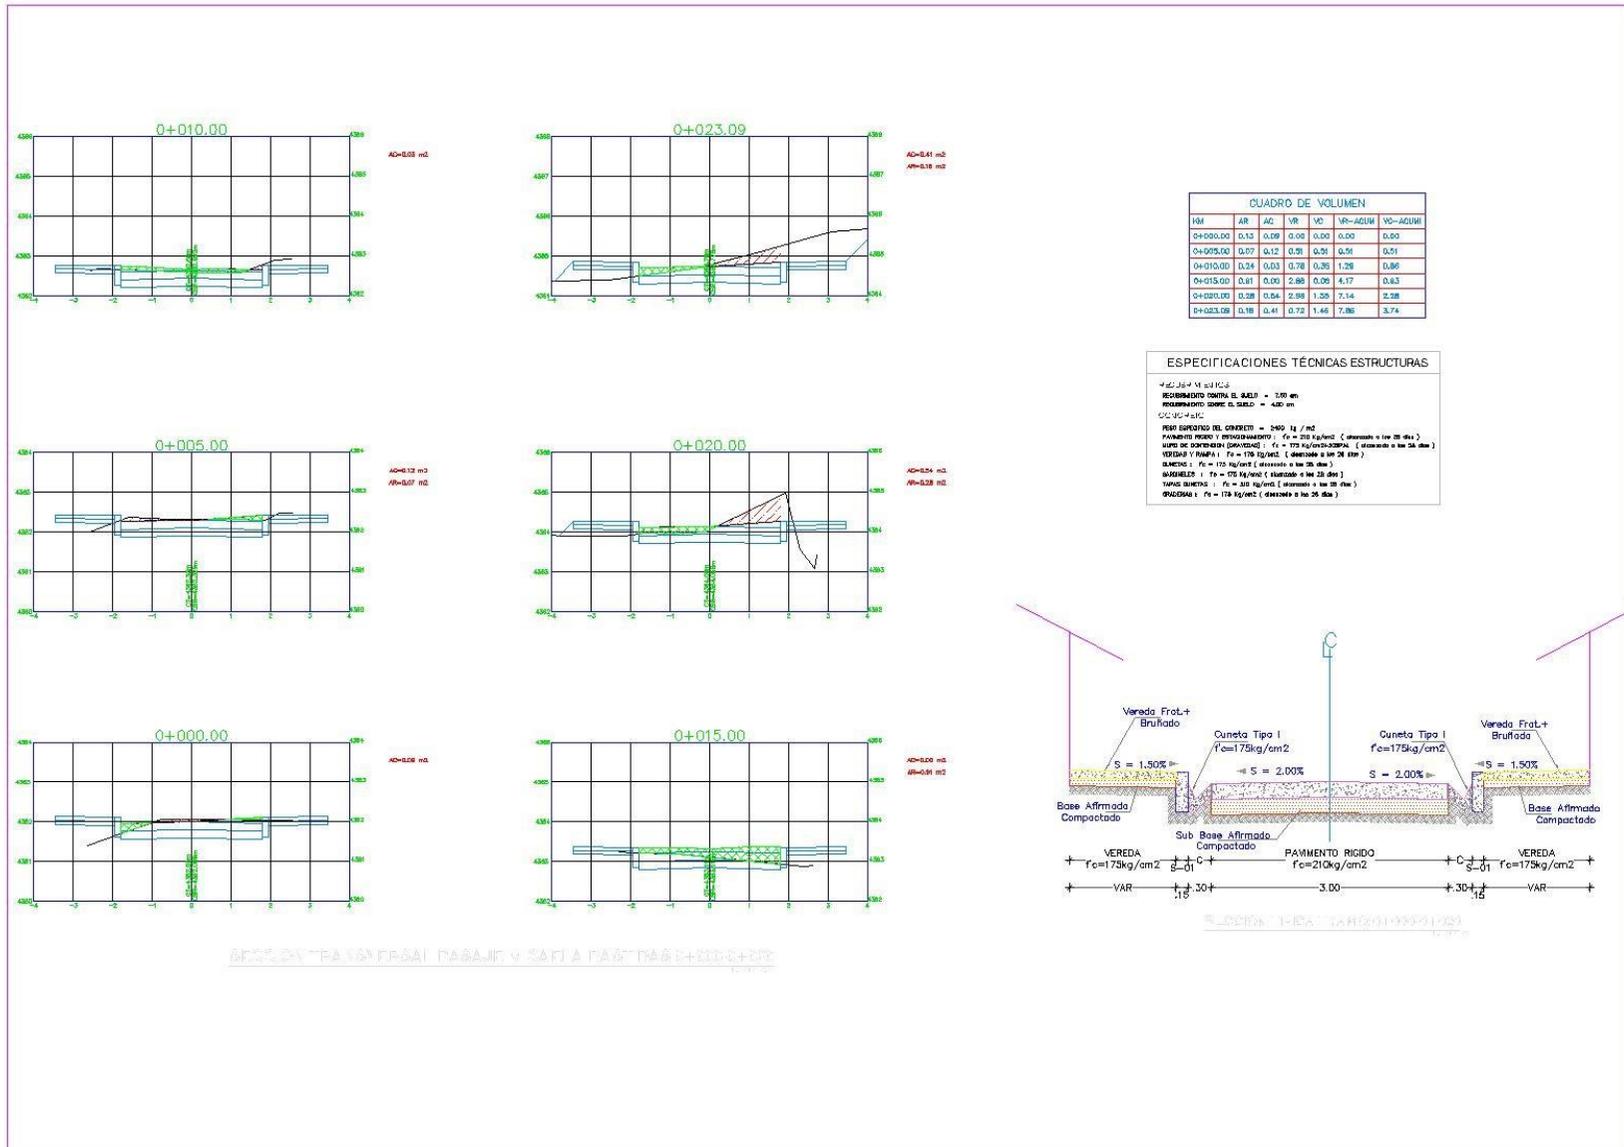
Plano Secciones Transversales Pasaje Tahuantinsuyo
